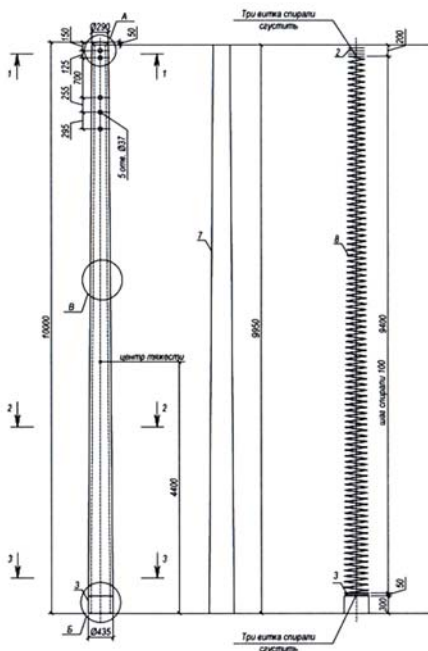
Схема продольного и поперечного (спирального) армирования стойки с композитной арматурой
